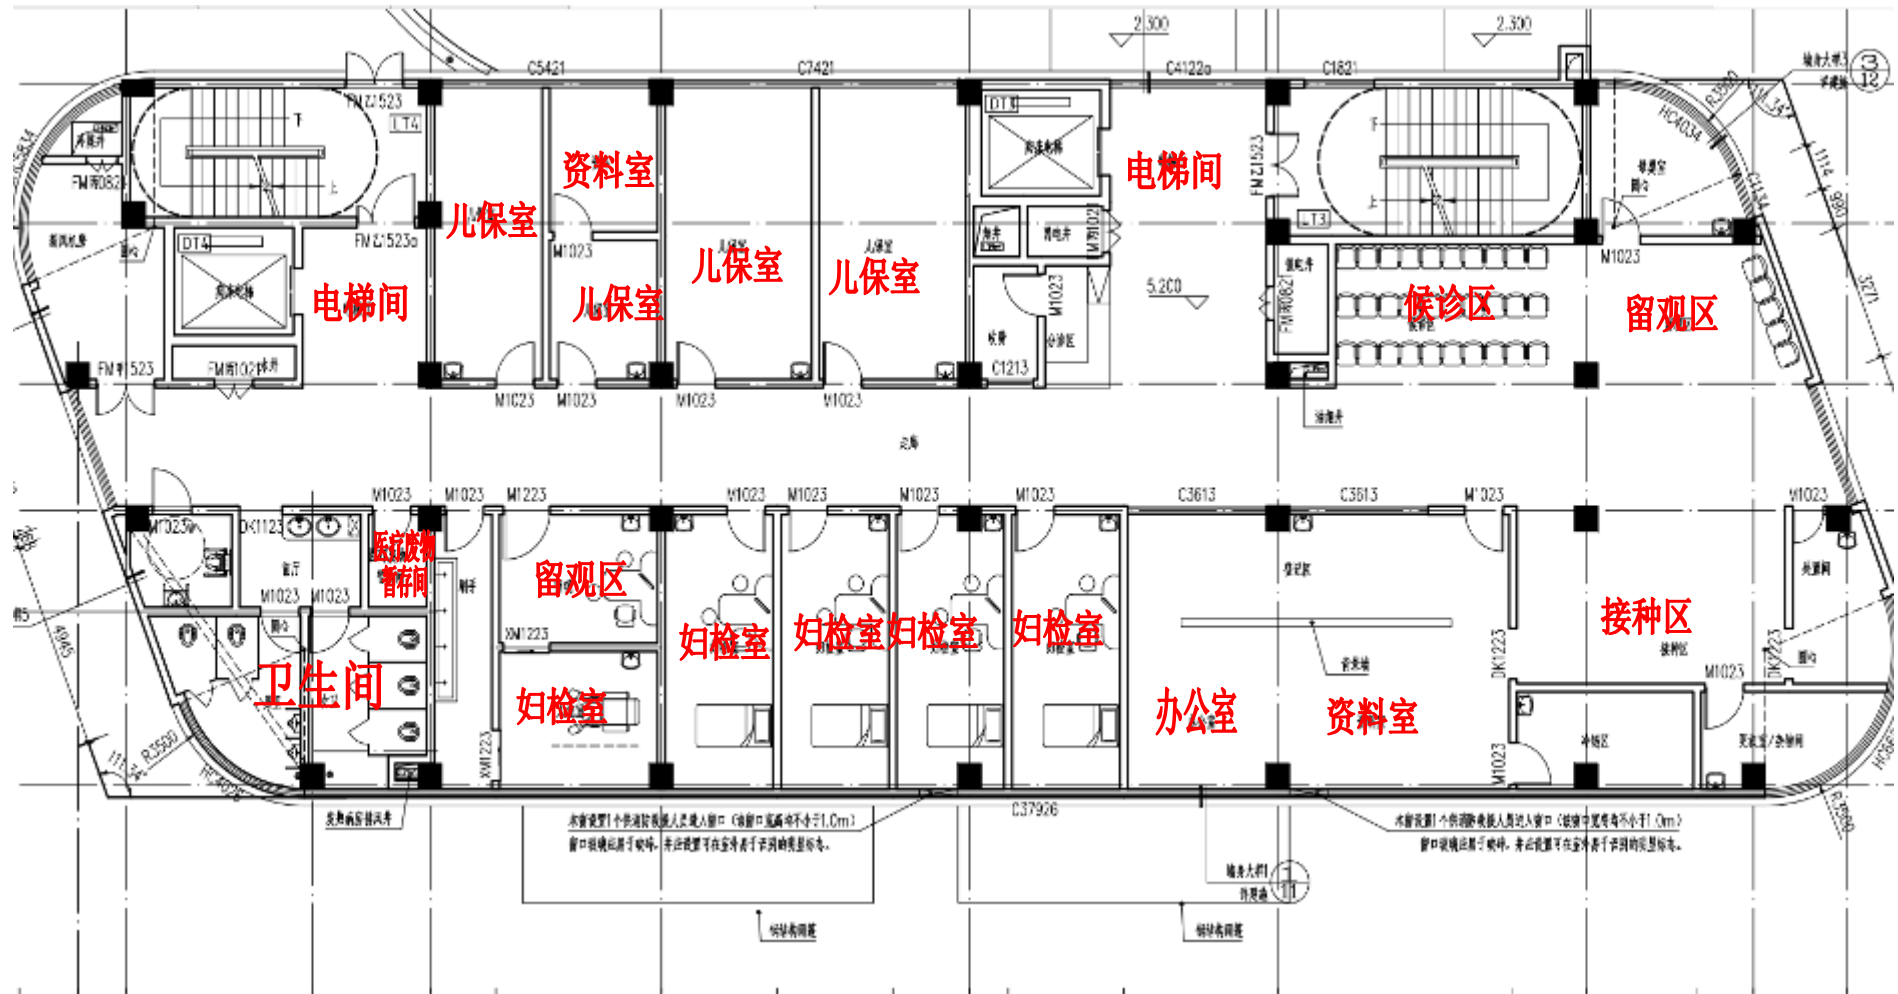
项目第二社区卫生服务中心大楼二层平面图
